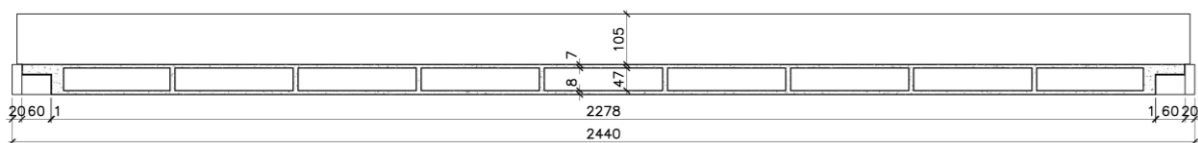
Projeto estrutural: corte longitudinal típico. Dimensões em (cm)
